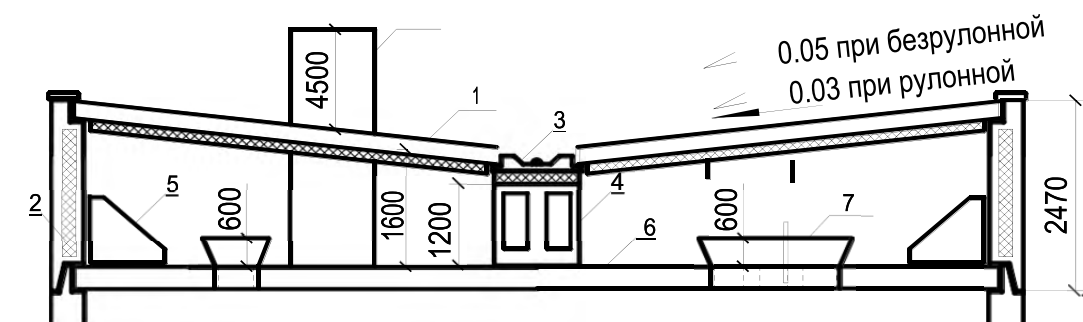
Схема крыши раздельной конструкции с теплым чердаком:
